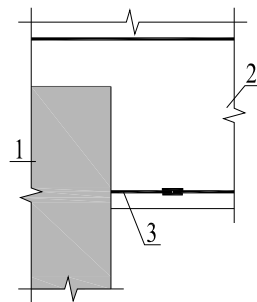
后浇连梁与预制剪力墙连接构造示意
